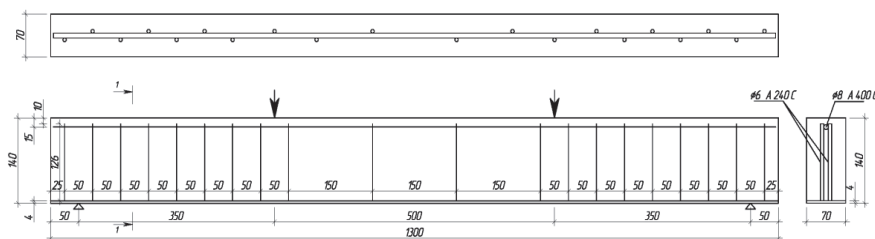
Конструкція і армування дослідних сталевих бетонних балок серії Б1 – Б3
